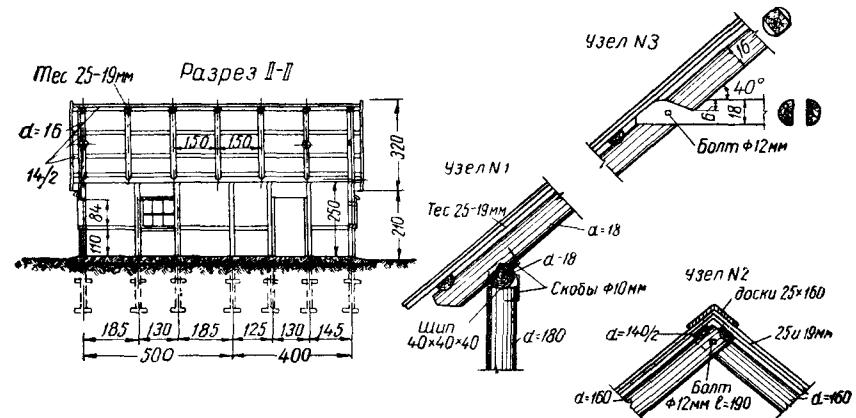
Разрез II-II и детали формовочного здания для агрегата СМ-296А
